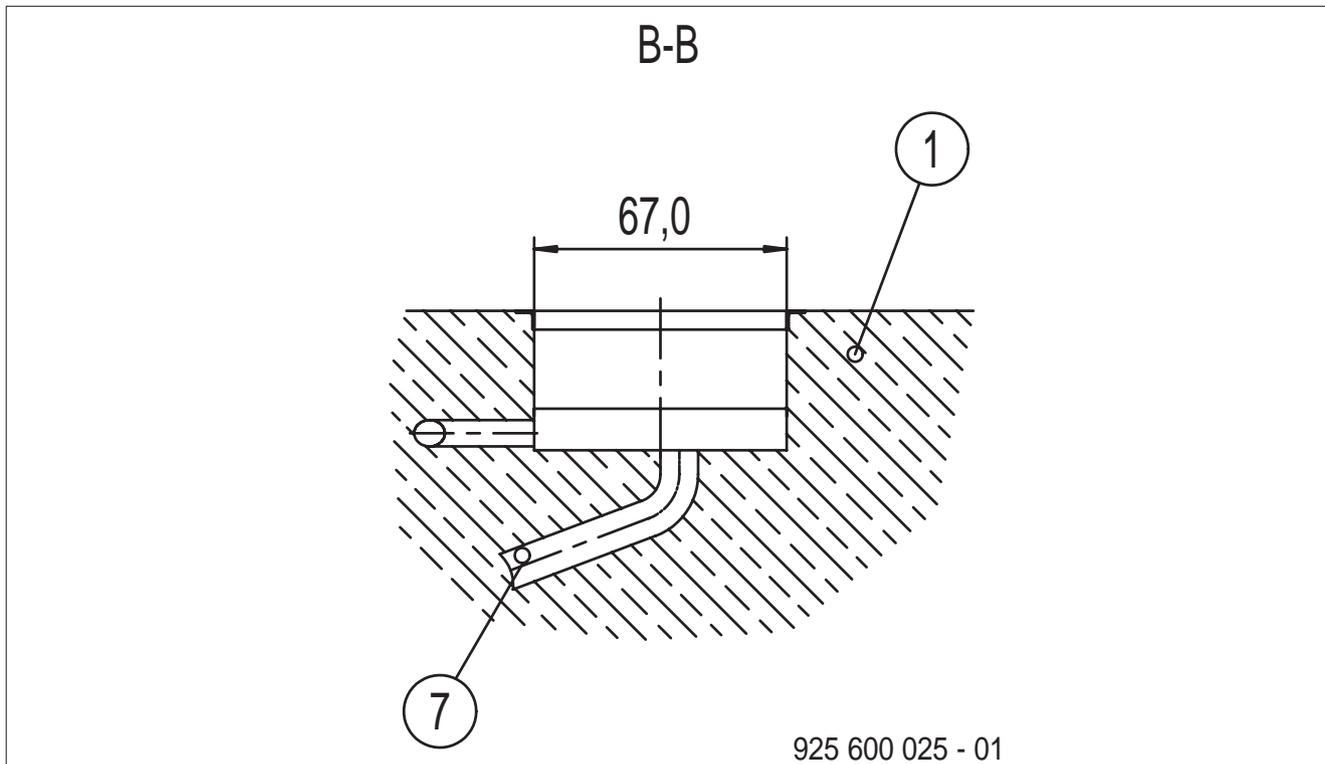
Grubenplan BD 6xx mit Wandhalterung - Schnitt B-B
